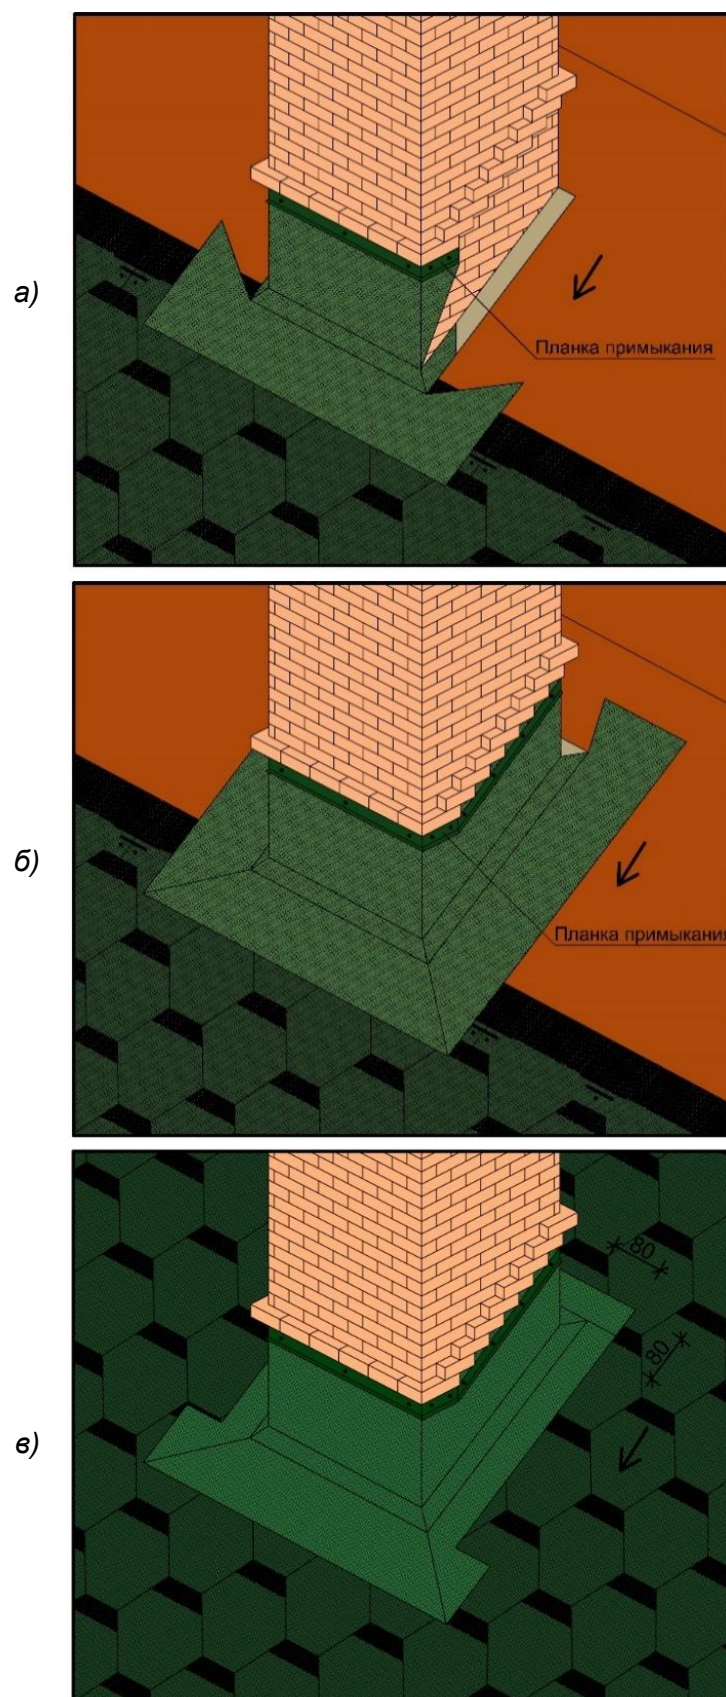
Примыкание кровли к трубе дымохода
